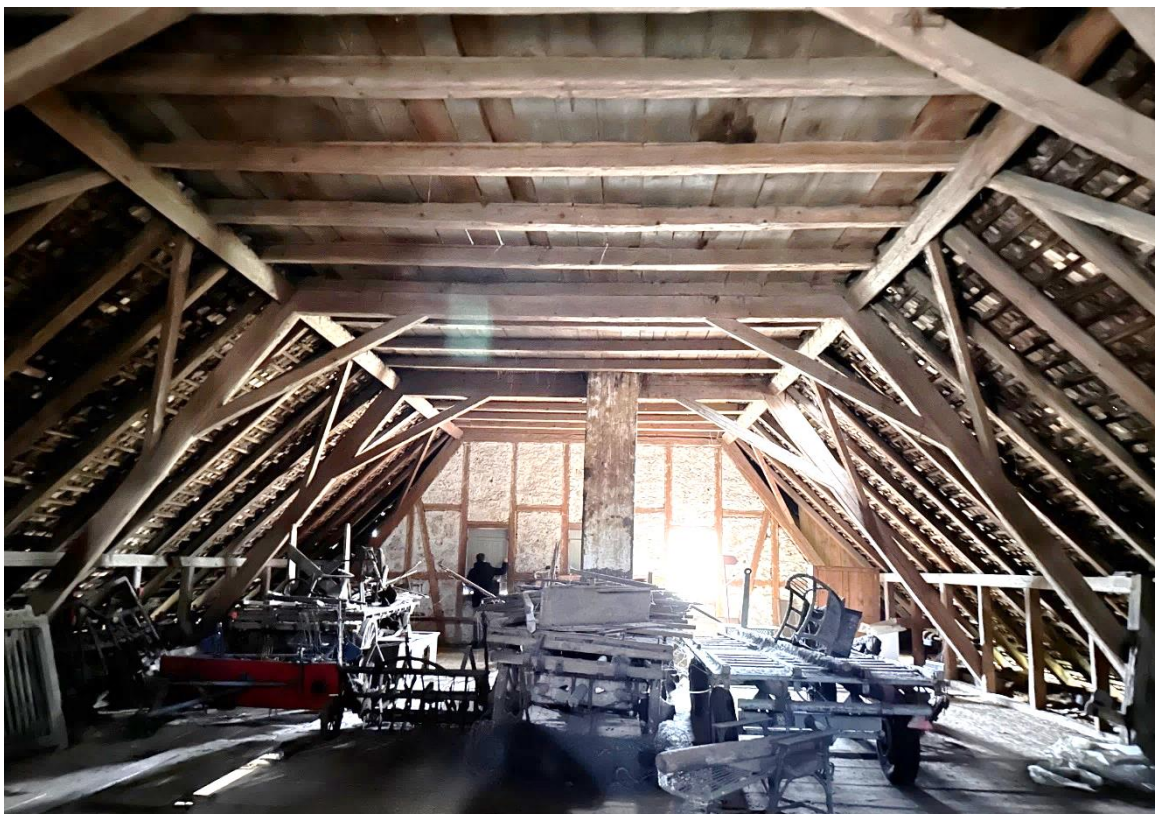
Dachgeschoss mit Blick auf Südfassade (dahinter Balkon, nur bedingt zugänglich)
